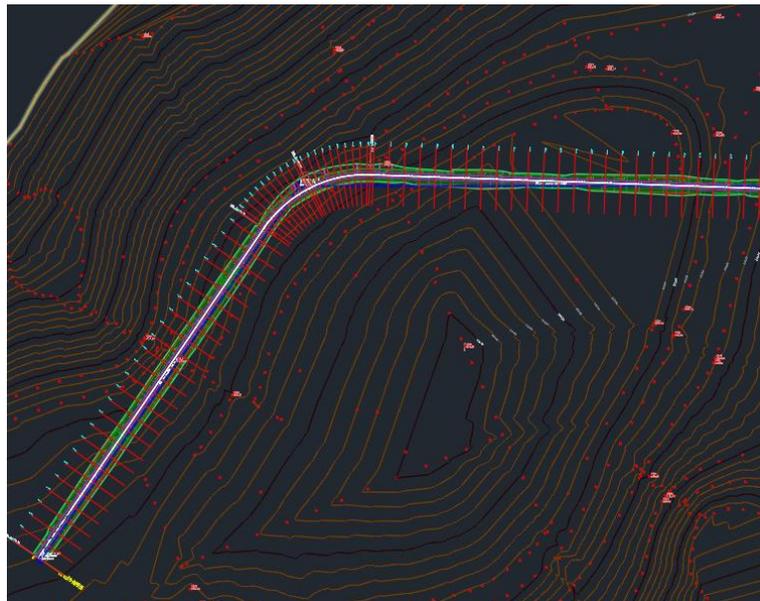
Vista en planta de una obra lineal con la barrera de seguridad entre fachas
